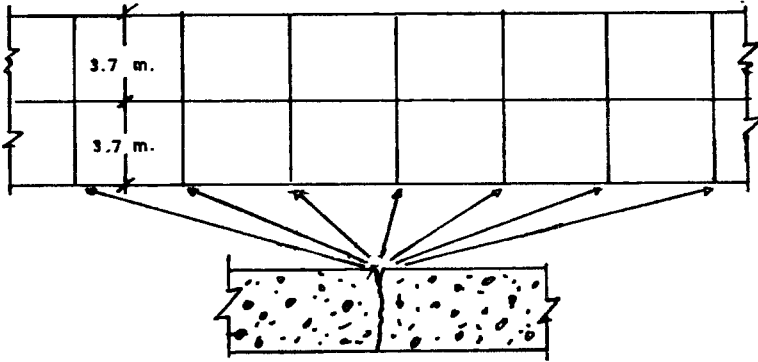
Pavimento de concreto simple juntas de contracción sin refuerzo
